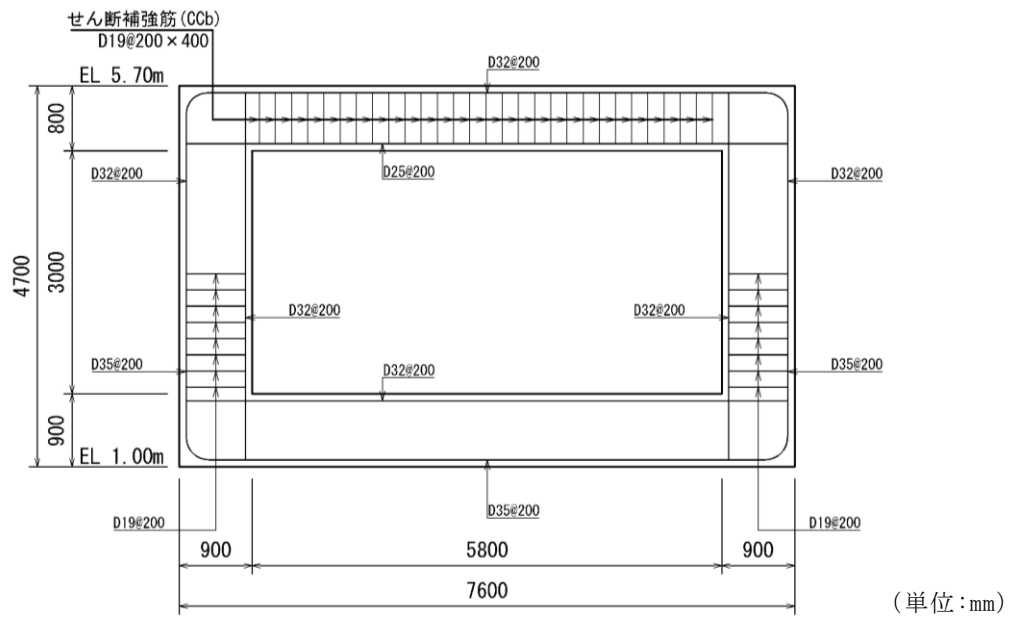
屋外配管ダクト (タービン建物～放水槽) 概略配筋図 (C-C 断面)
